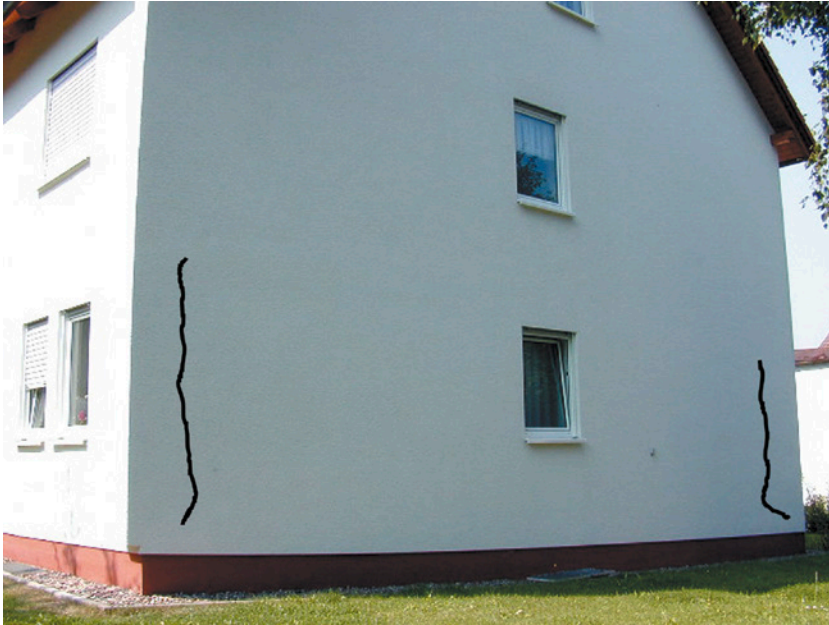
Vertikalrisse (nachgezeichnet) in den Eckbereichen des Erdgeschosses eines Wohngebäudes aus Porenbeton-Mauerwerk
